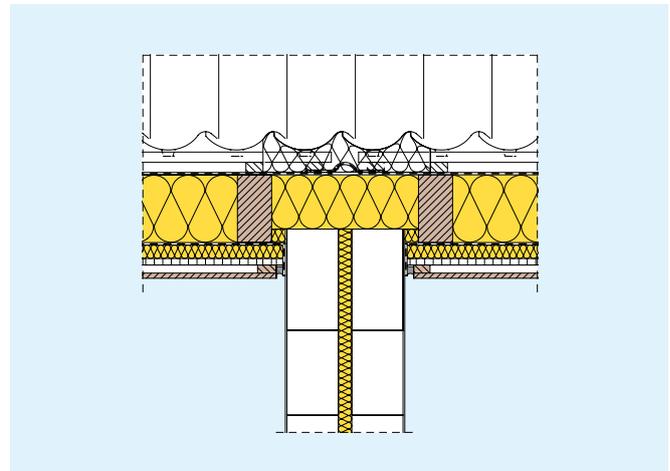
Dachanschluss bei einer zweischaligen Haustrennwand ohne durchlaufende Dachlatten (Brandschutz der jeweiligen LBO beachten)
